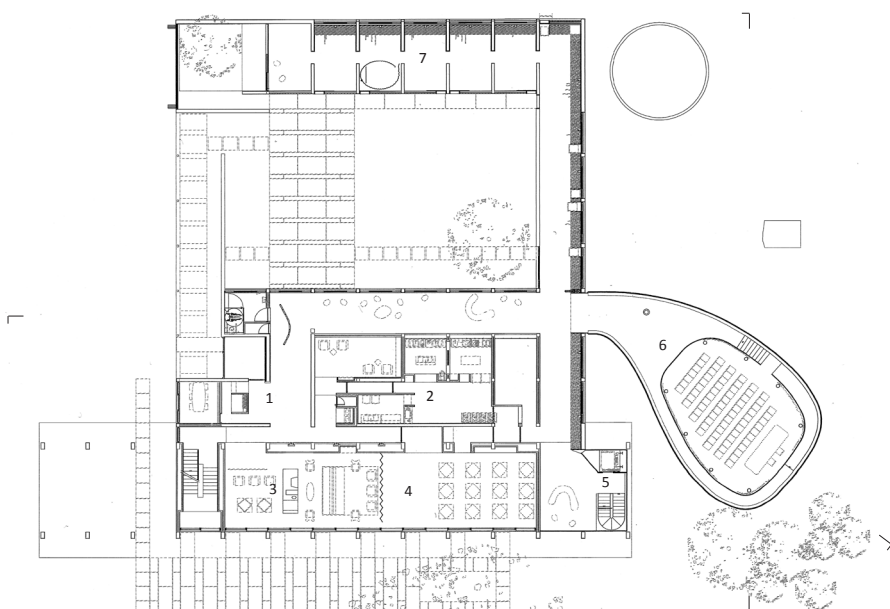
Planta Piso 0 - Segunda proposta de intervenção.
